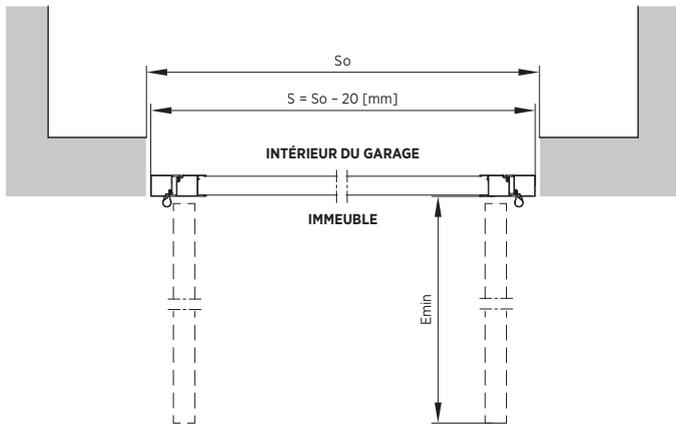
Pose dans la baie - coupe horizontale - Porte battante à deux vantaux Presto 50
